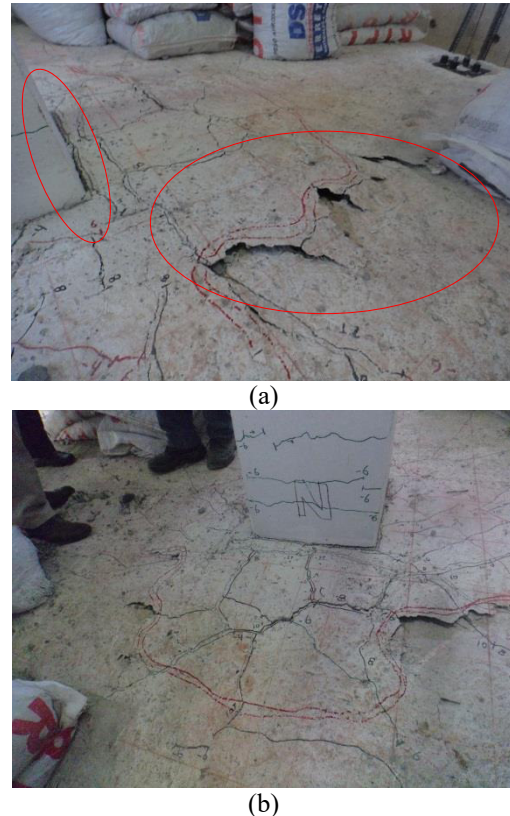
Zona de agotamiento, falla por punzonamiento. (a) Área de punzonamiento, (b) Fisura alrededor de columna.
